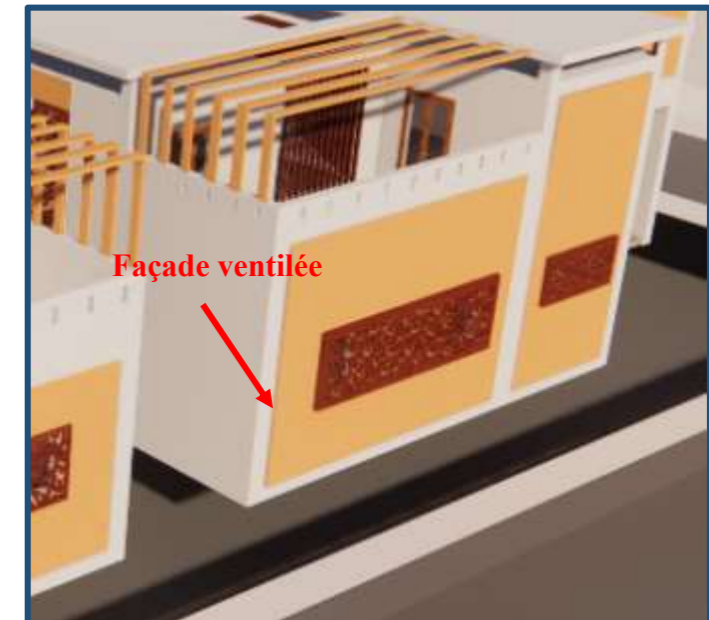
Photo d'une des façades de la résidence avec moucharabieh et façade ventilée.
